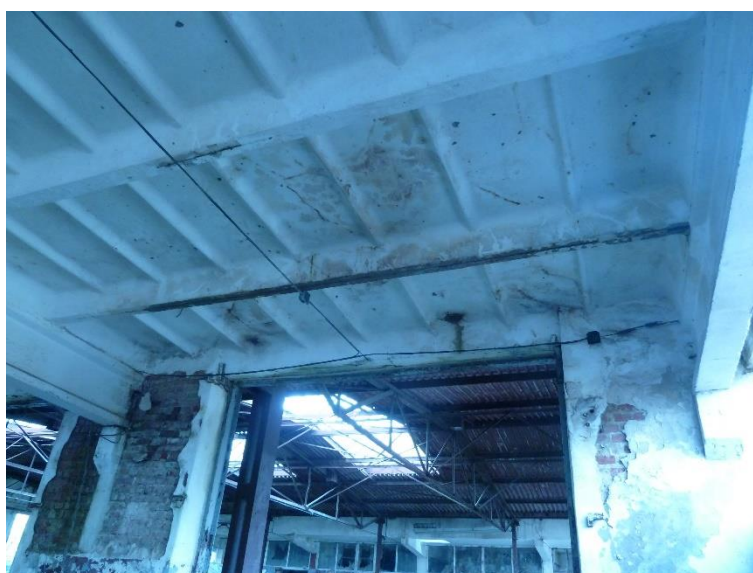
Stan zniszczenia konstrukcji płyt dachowych.
